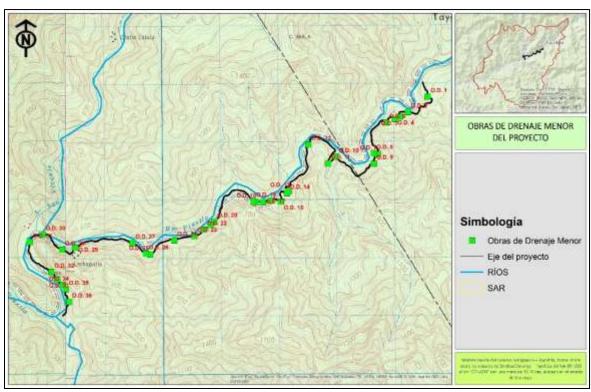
Ubicación de las 36 obras de drenaje menor del proyecto.
